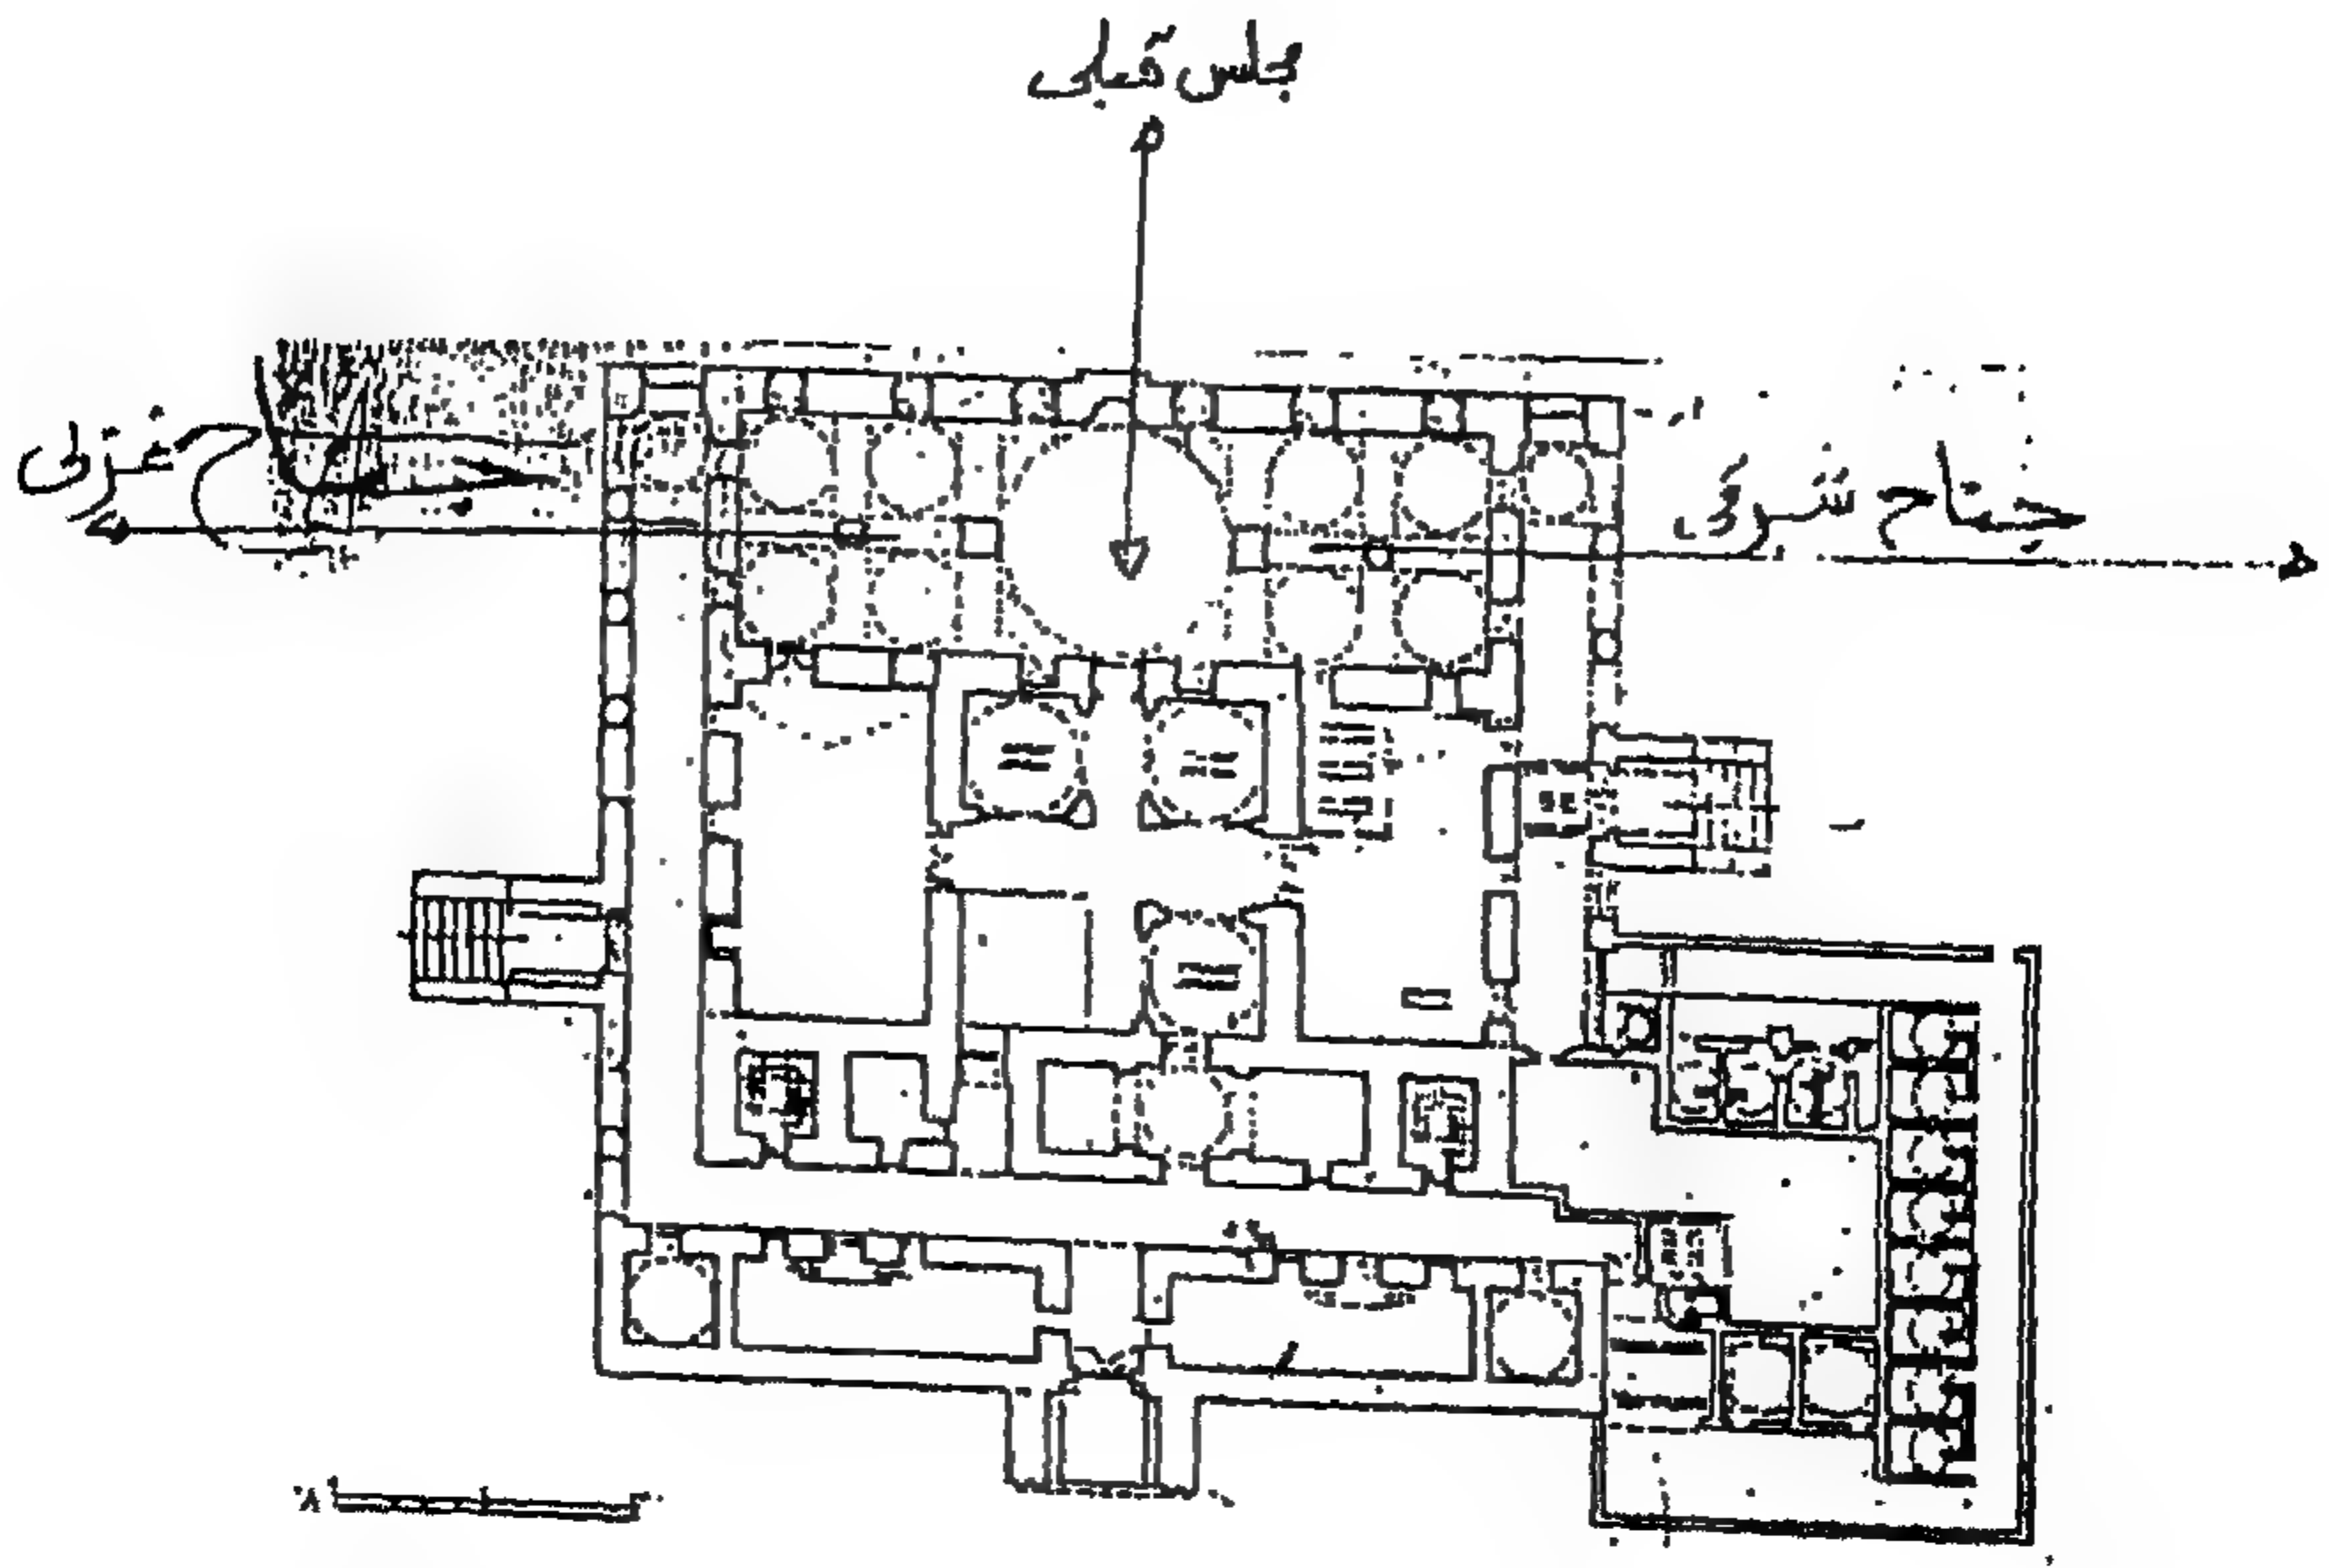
مسقط أفقي لمسجد تميم باليمن (عن : فتستر) .
